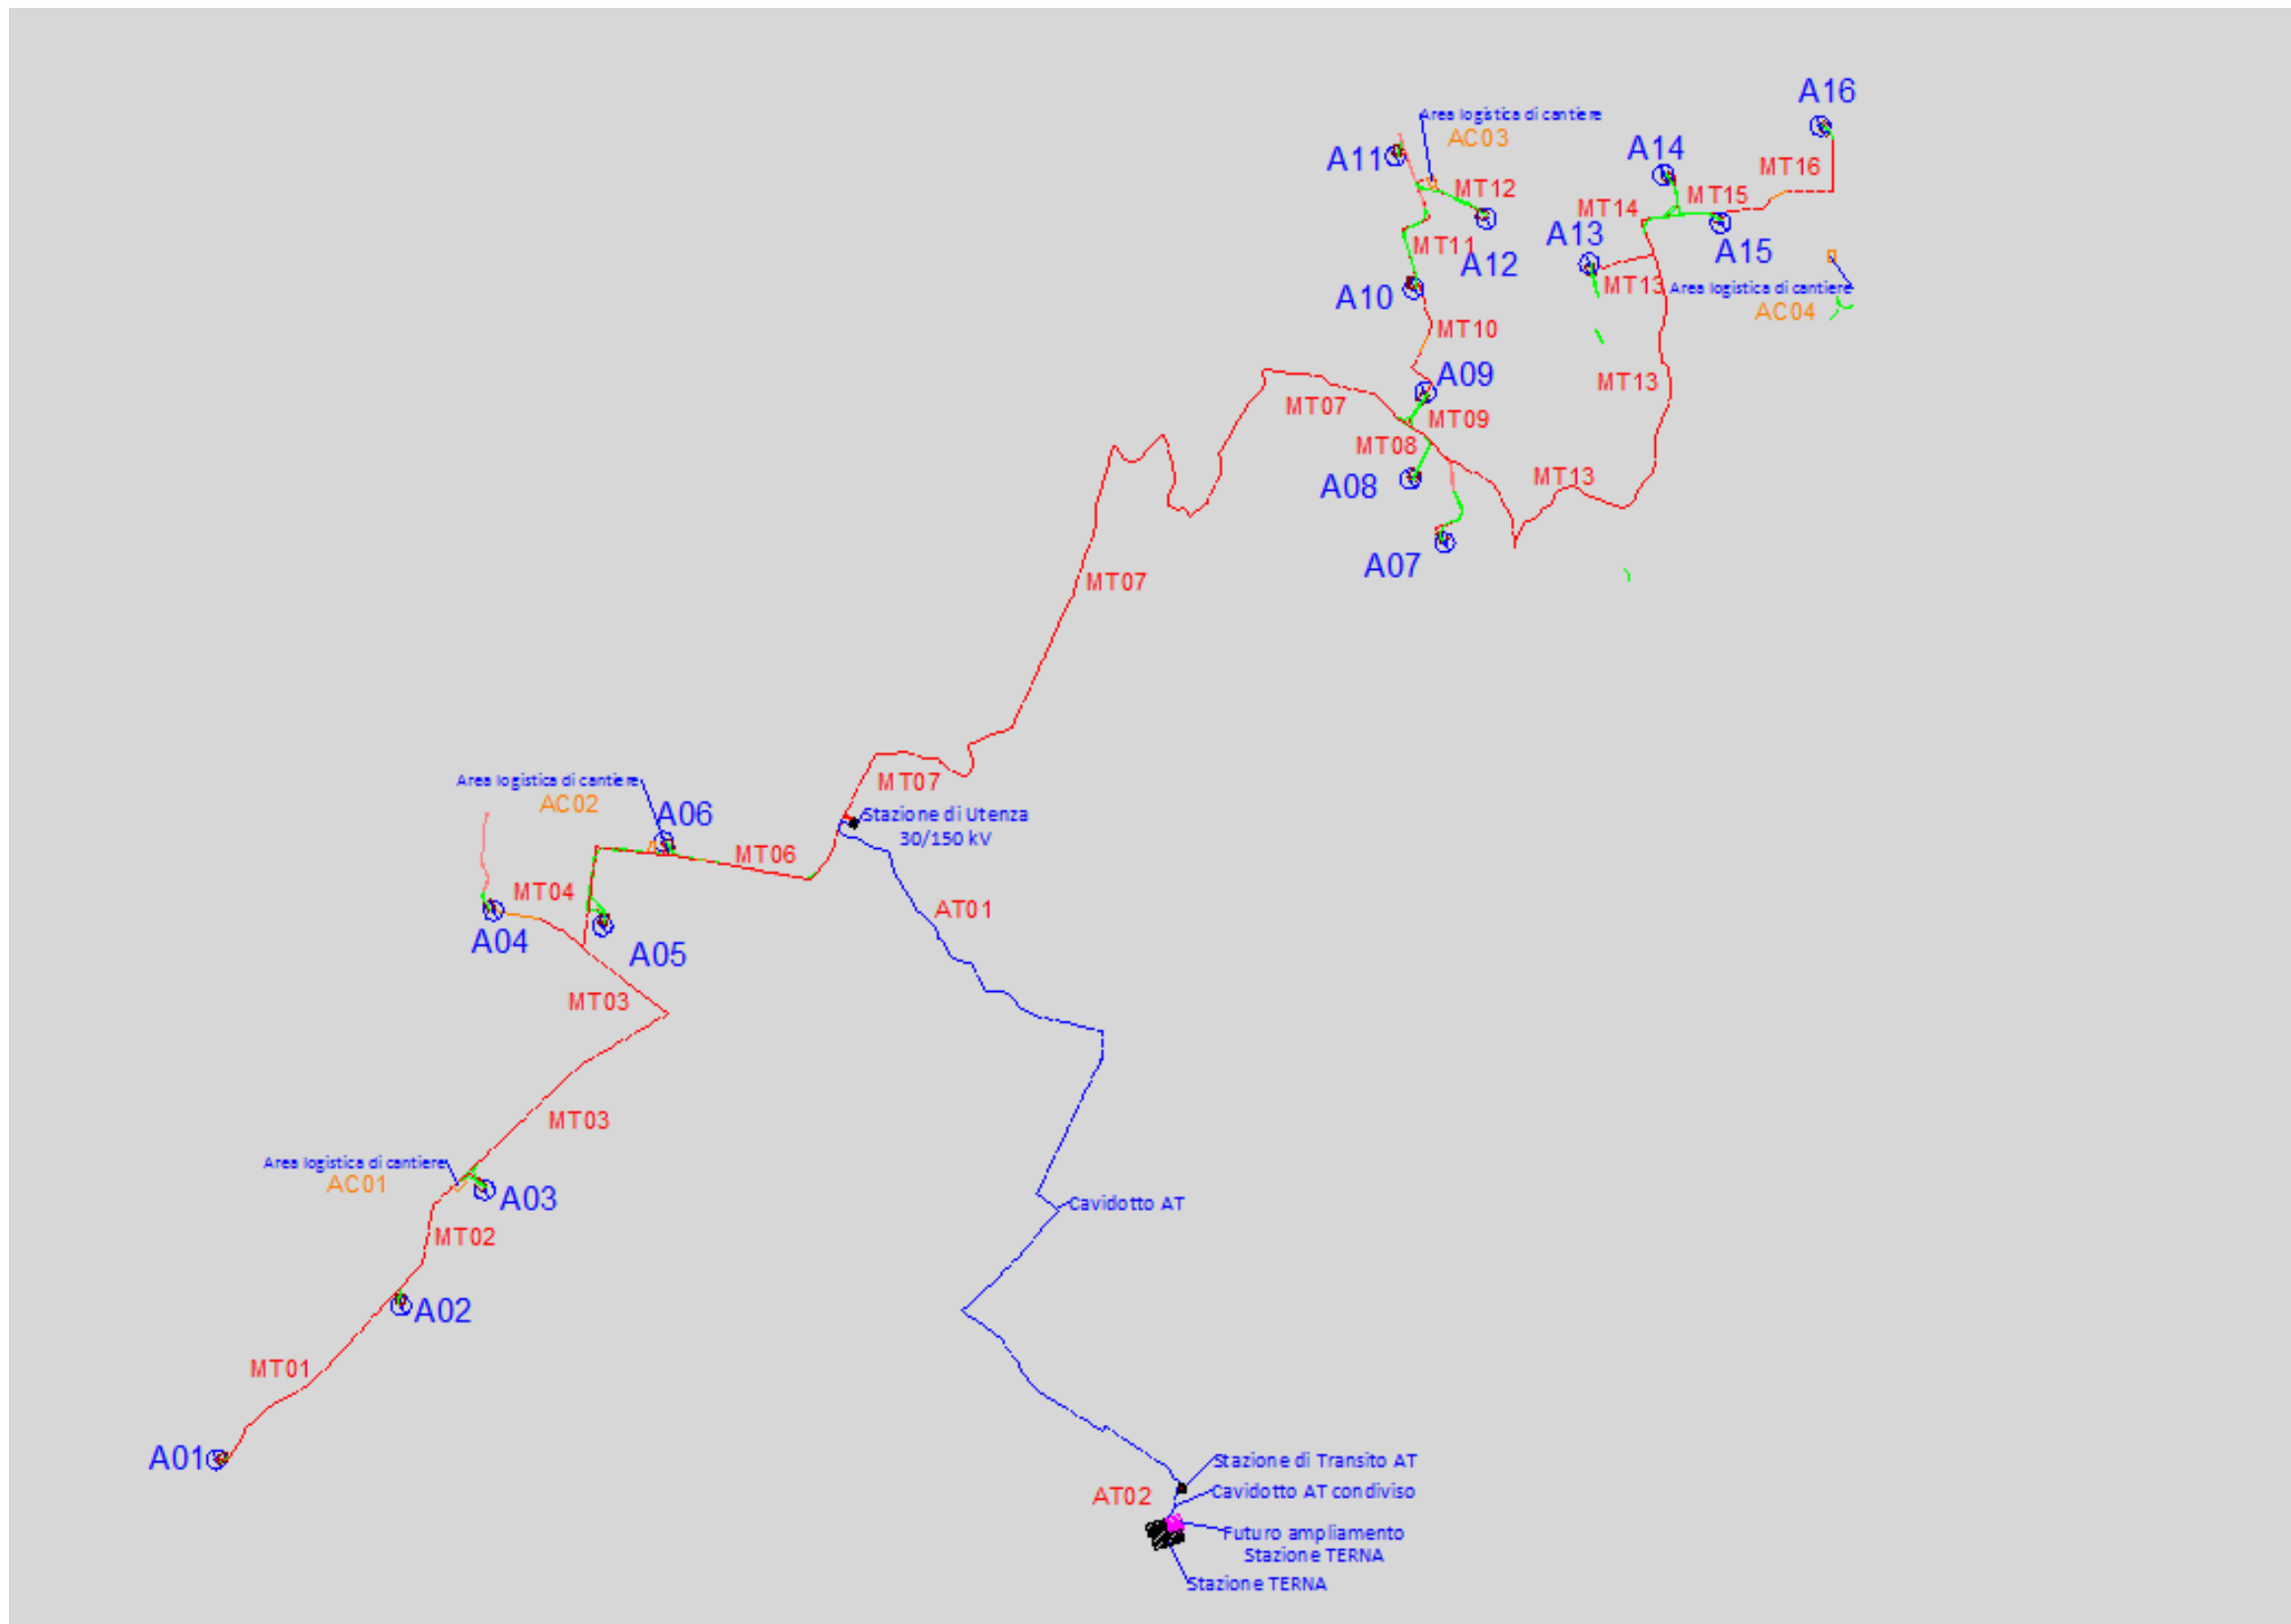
Schema del progetto, con individuazione dei due sottocampi, delle WTG, delle aree di cantiere, della SE Utente, del tracciato del cavidotto interrato MT (in rosso) e AT (in blu) di collegamento alla SE TERNA "Tuscania".
